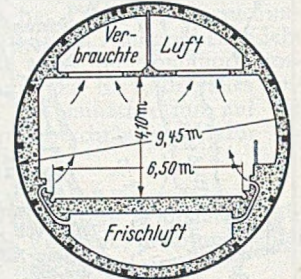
Querschnitt des Brooklyn-Battery-Tunnels (gilt mit geringfügigen Abweichungen auch für den Queens-Midtown-Tunnel).
